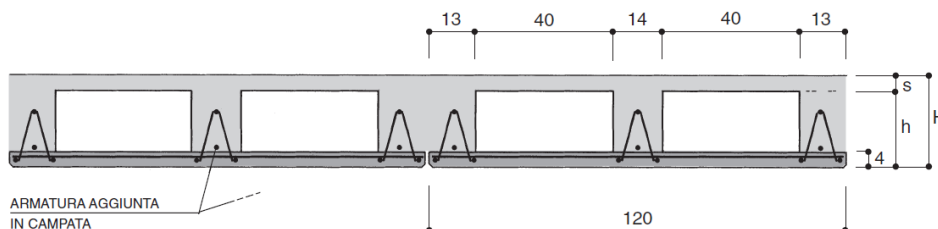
Sezione trasversale lastre prefabbricate di solaio
